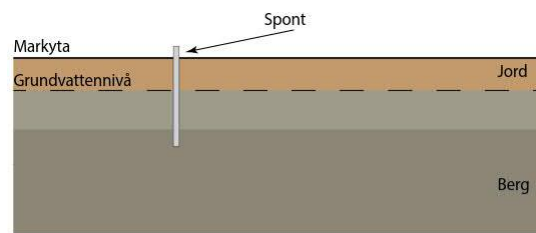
Principskiss för schakt och stödkonstruktioner vid anläggandet av betongtunnel. Samma principer gäller i stort sett för schakt och stödkonstruktioner vid anläggandet av träget.
